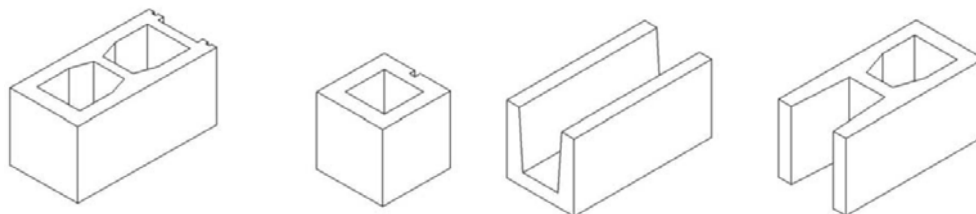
Bloque de esquina y medio bloque de árido denso. Bloques en "U" para crear zunchos o vigas de hormigón armado.
